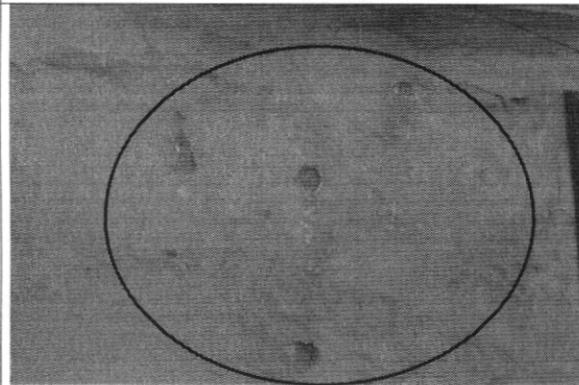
desprendimiento de acabados en muros segundo y tercer piso, costado sur
